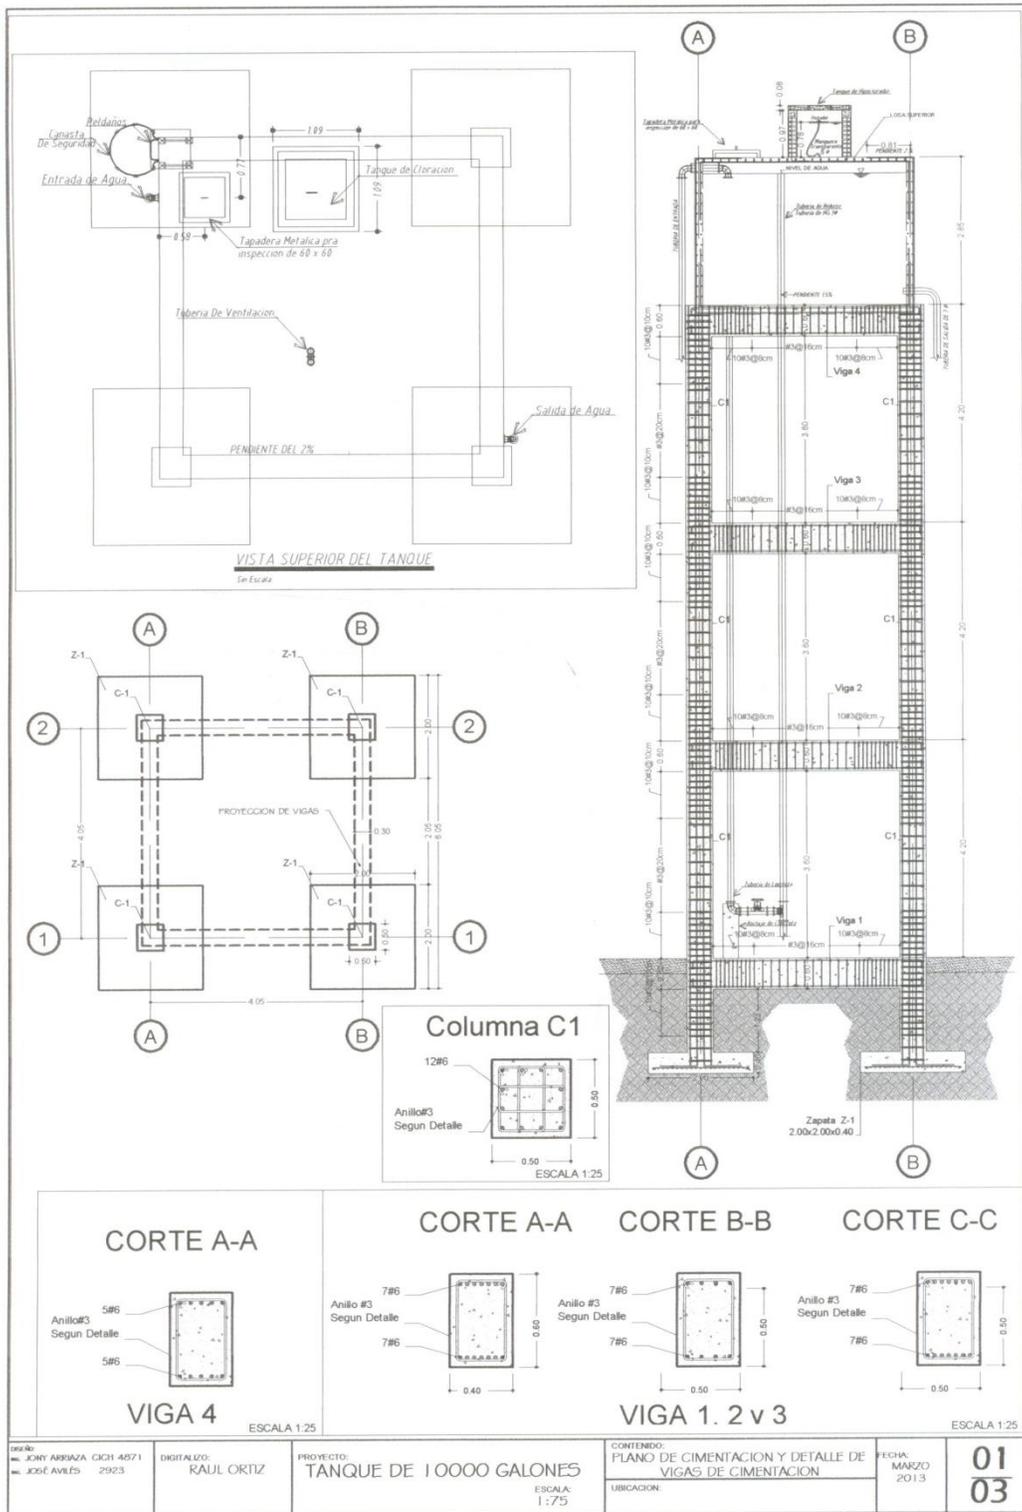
Plano Estructural de Cimentación Tanque 10,000 Galones.
